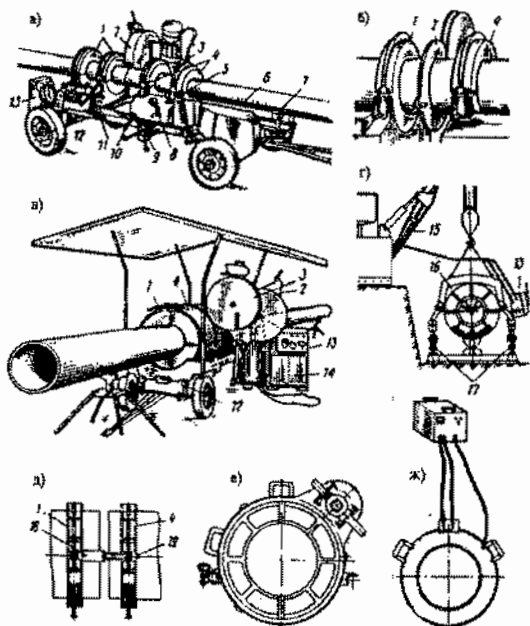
Установки и оборудование для сварки пластмассовых (полиэтиленовых) труб: а - установка для сварки труб диаметром 160 - 315 мм; б - деталь сварочного узла; в - установка для сварки труб диаметром 355 - 630 мм; г - то же, диаметром 710 - 1200 мм; д, е, ж - комплект для сварки труб диаметром 710 - 800 мм (д - центратор; е - торцующее устройство; ж - электронагреватель с источником питания); 1 - неподвижные хомуты; 2 - электронагревательный диск; 3 - торцевальной механизм; 4 - подвижные хомуты; 5 - переключатель; 6 - привариваемая труба; 7 - ролик; 8 - манометр для контроля усилий; 9 - система переключений; 10 - зажим; 11 - привод торцевого механизма; 12 - тележка; 13 - пульт управления; 14 - навесная станция; 15 - трубоукладчик-бульдозер; 16 - сварочная установка; 17 - направляющие пути; 18 - гидроцилиндры; 19 - направляющие
